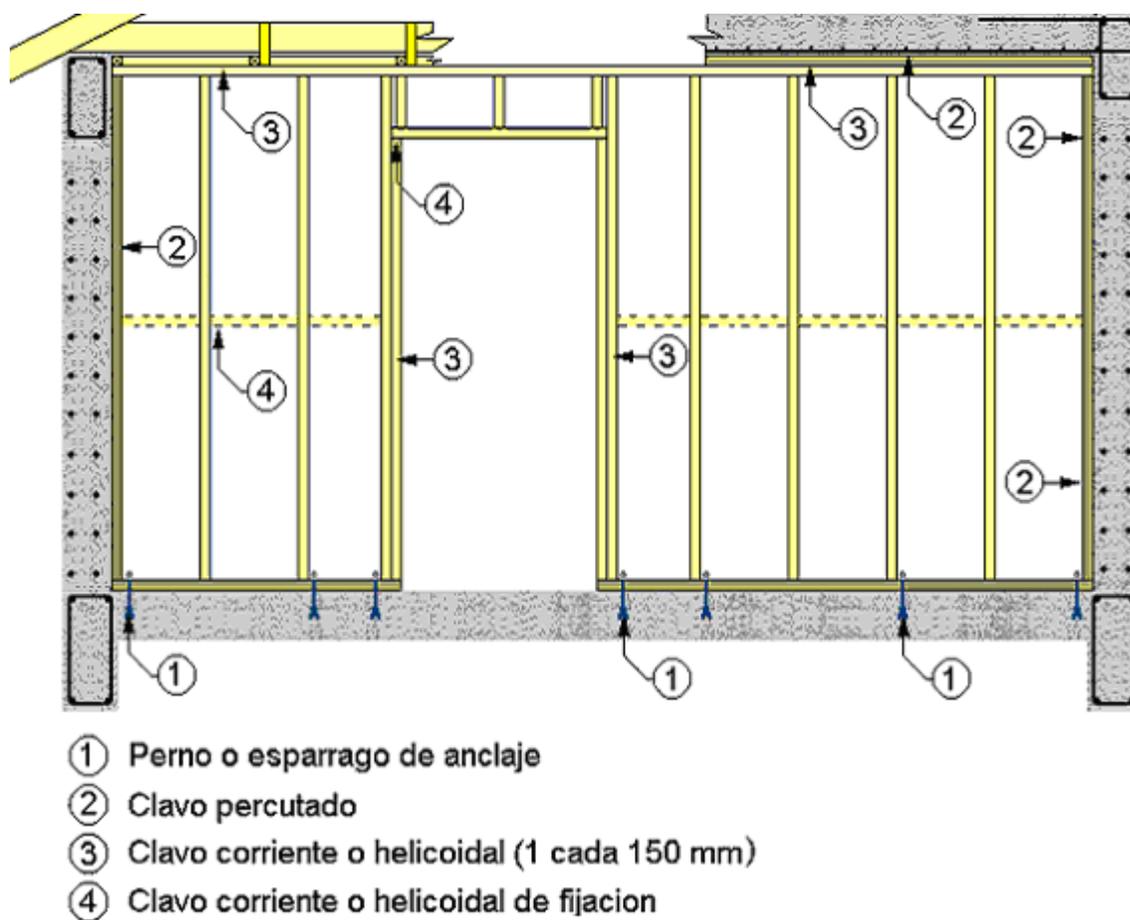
Detalle constructivo que indica la forma de unión entre el tabique y la estructura. Fuente: Elaboración propia.
